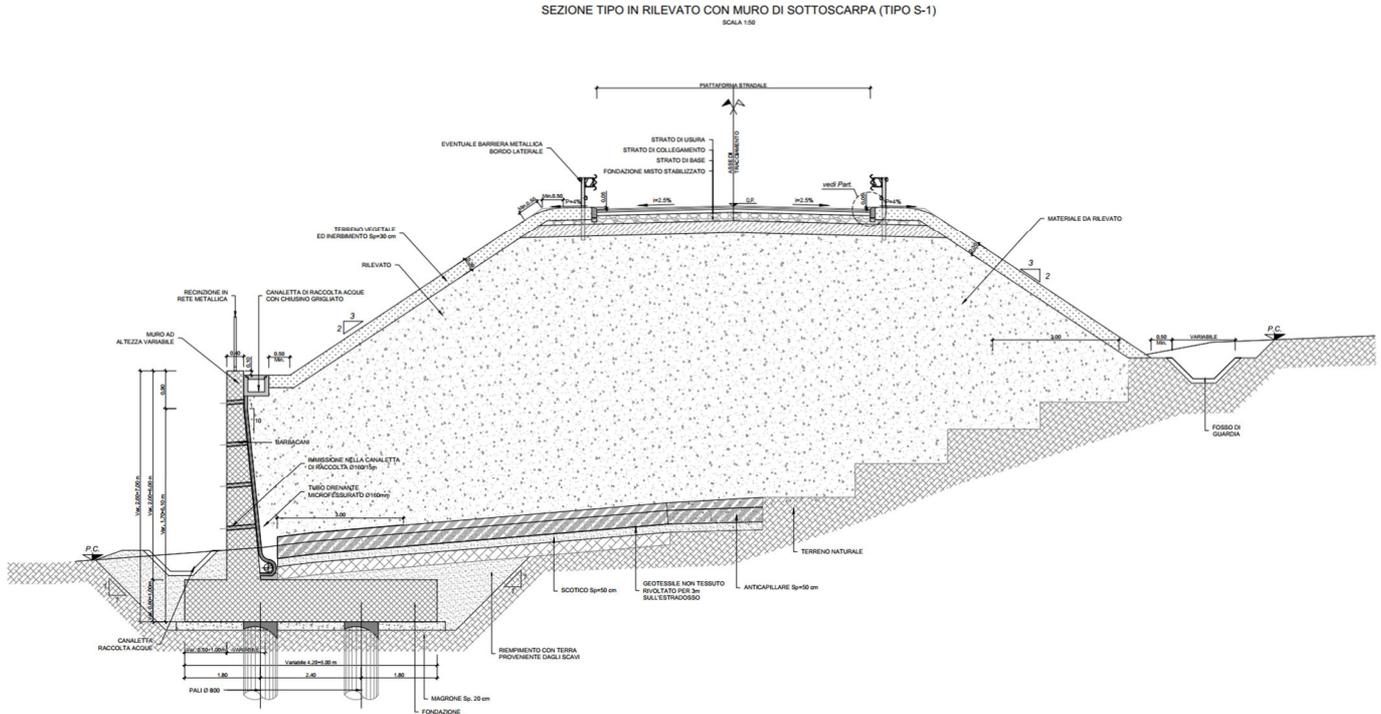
Sezione tipo in rilevato con muri di sottoscarpa (tipo S-1)
